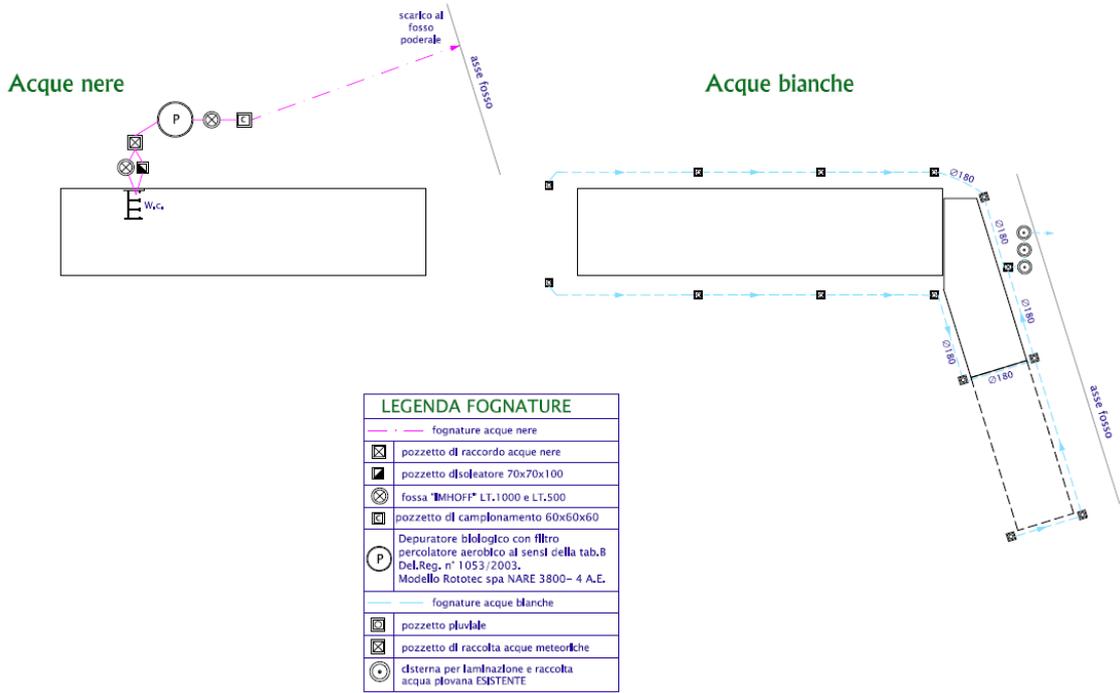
Estratto Tavola 2 - Stato modificato – Piante Sezioni e prospetti
